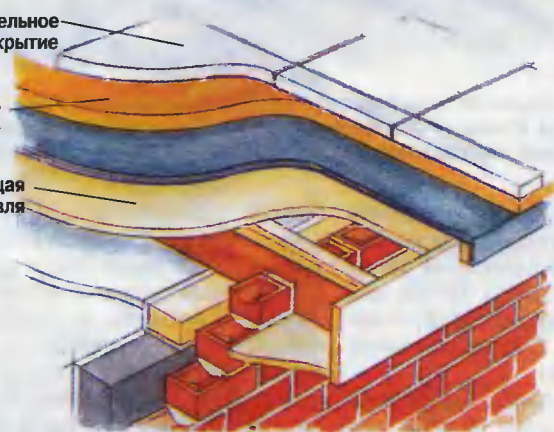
Если настил крыши в хорошем состоянии, поверх него укладывают плиты изоляции и накрывают их легким кровельным материалом
